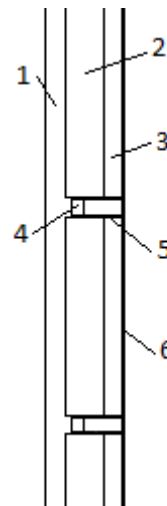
Конструкция многослойной обмуровки котлоагрегата
